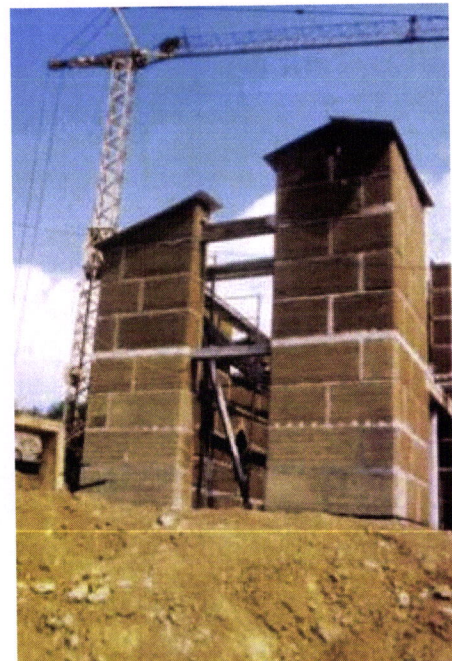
FRANÇA – Saint Etienne – Construção em taipa pré-fabricada.
